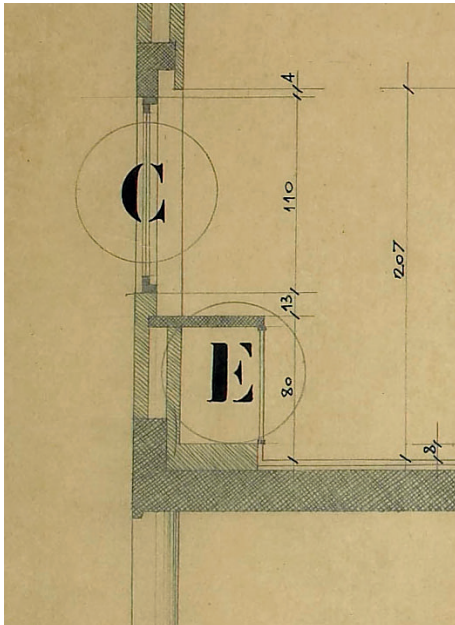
Detalle "E" de la sección constructiva de la *Villa Savoye* a escala 1:20, Atelier LC-PJ. FLC 19448 (pormenor 1).
